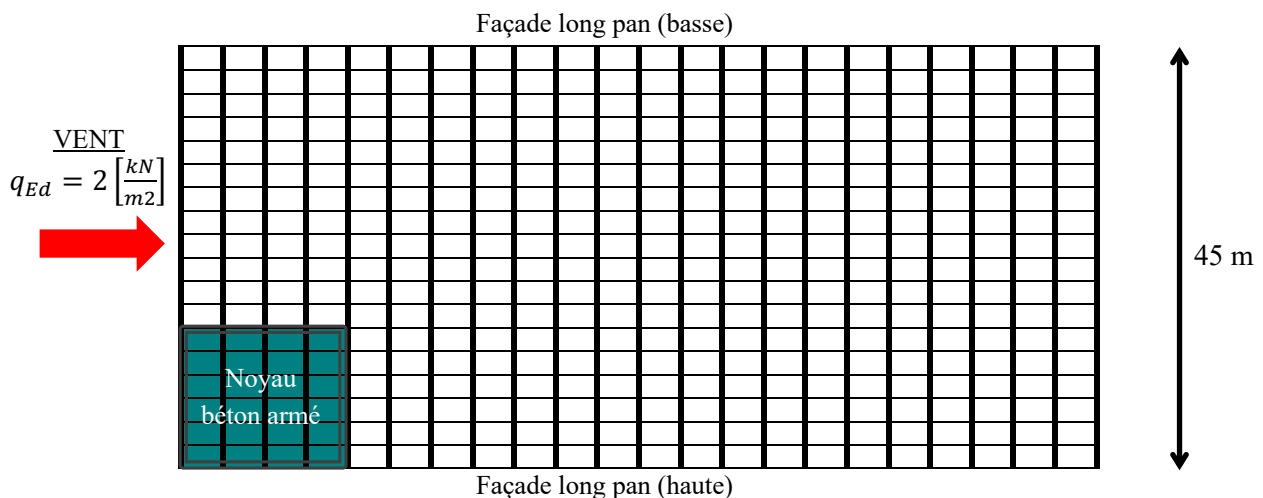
vue en plan de la trame de la halle, sans contreventements.
